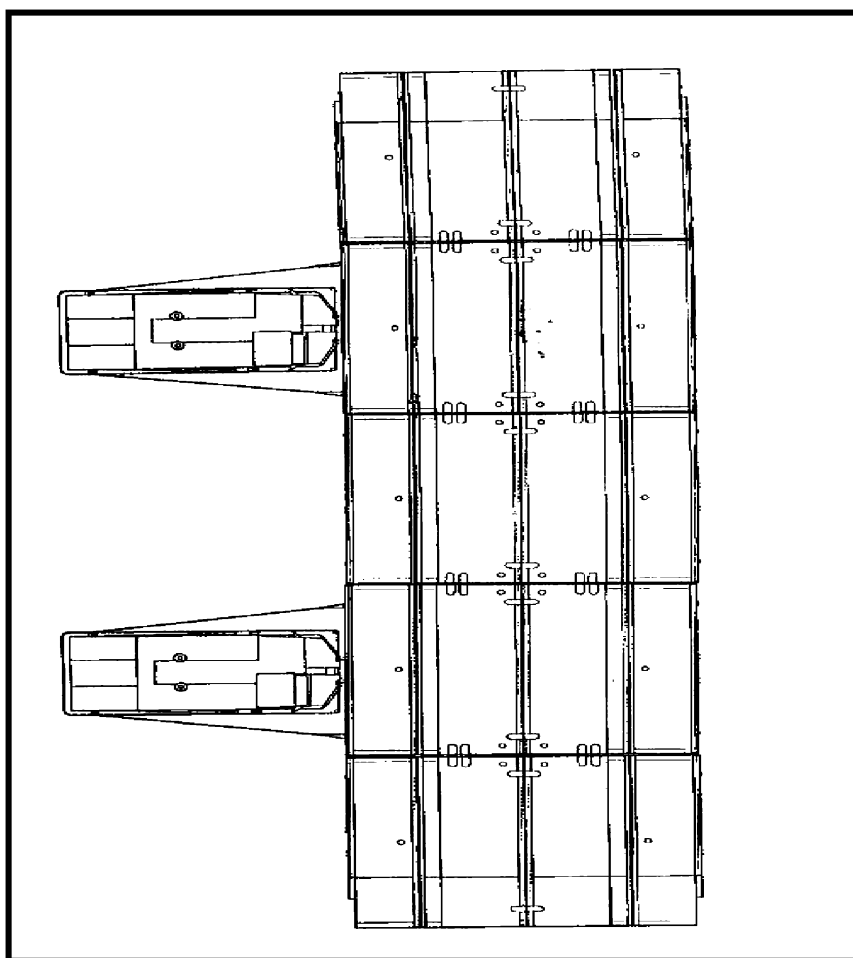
Portada de cinco módulos com embarcações perpendiculares à faixa de rodagem
